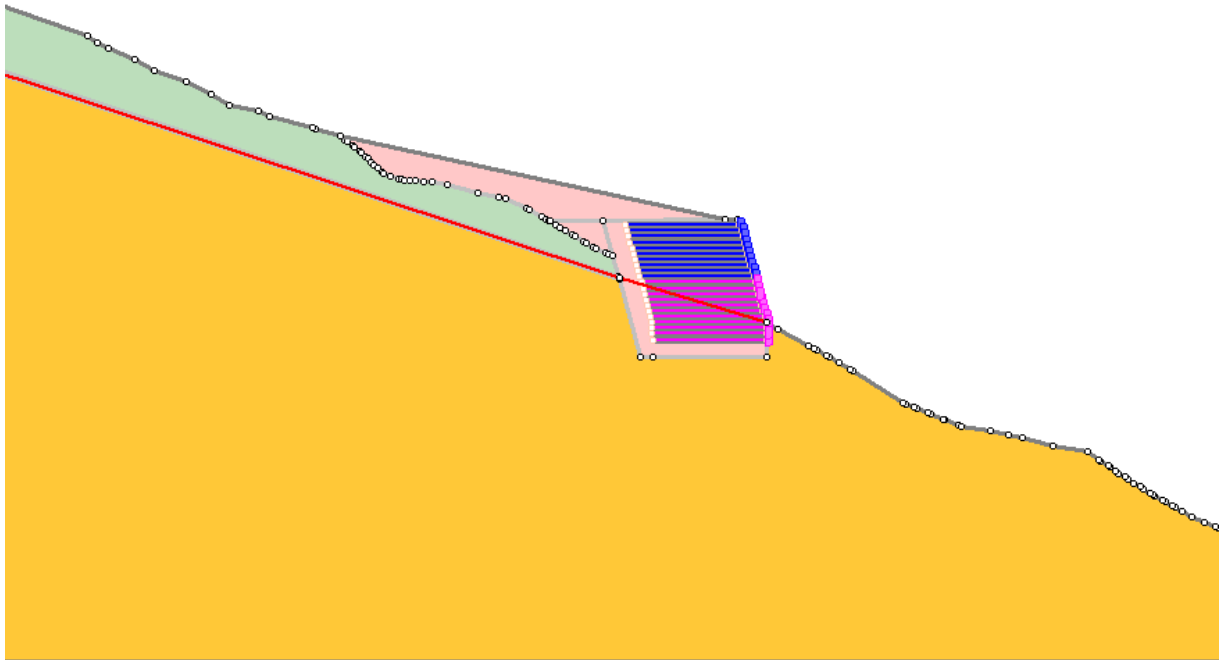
Modelo con muro en tierra armada perfil 4
